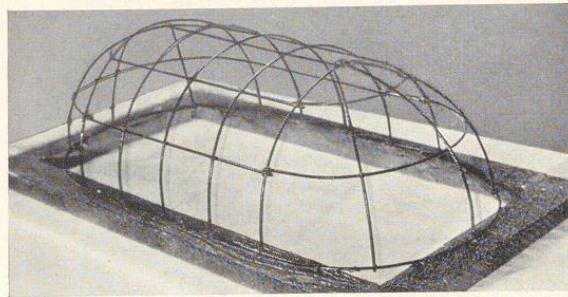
Muldengewölbe mit kreisrundem Abschluß, zum Aufsetzen auf eine Rabitzdecke
